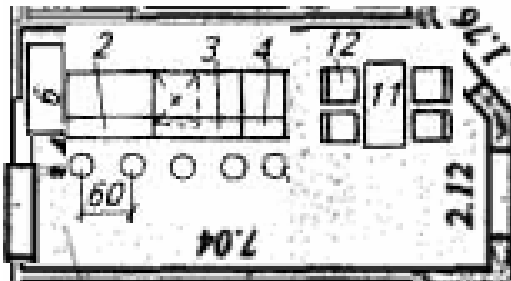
Планировка бара (повернут по отношению к планировке 1 этажа)
